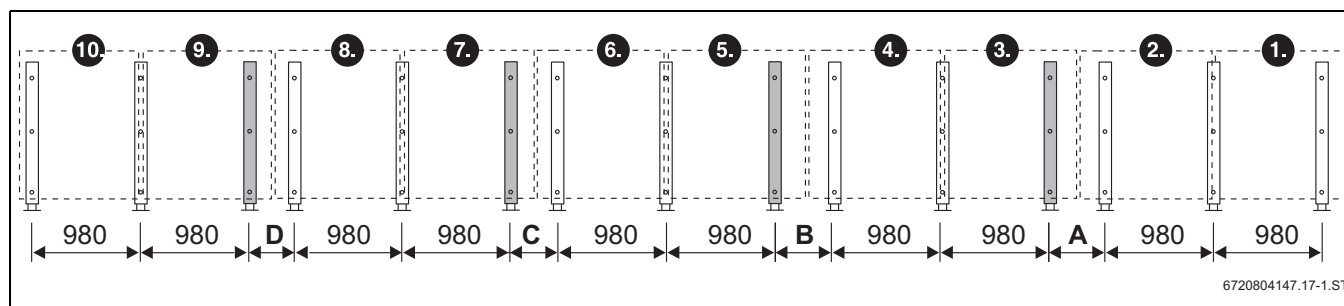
Grundauführung Beschwerungswannen, 10 senkrechte Kollektoren (Angaben in mm)
